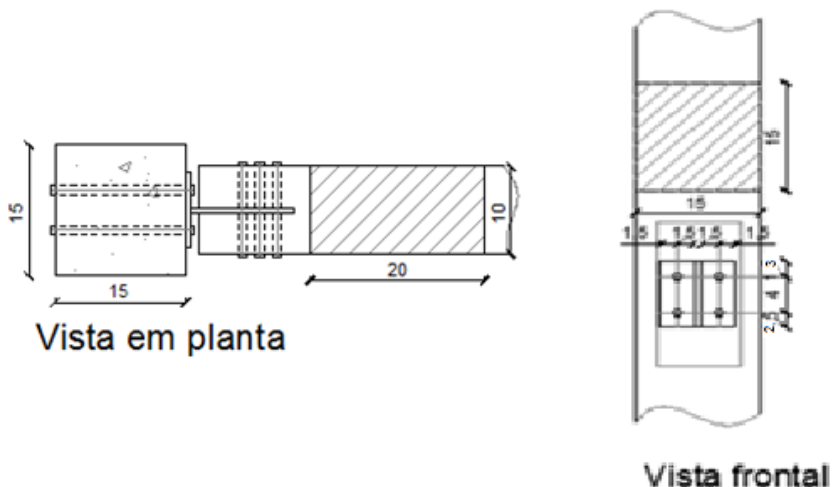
Detalhamento ligação VM 08 com PM 08 vista em planta e frontal. Fonte: do autor
